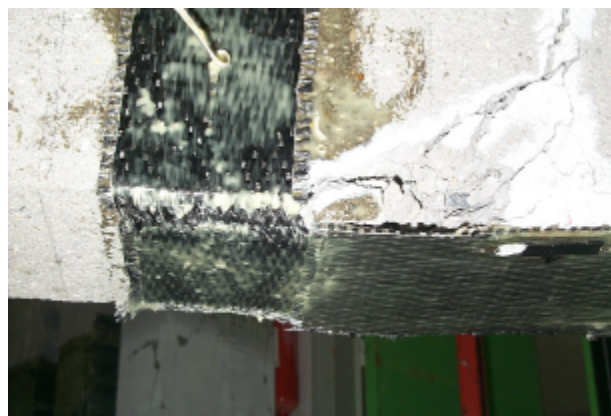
Rupture du TFC latéral et du béton (poutre n°16, HA8)
